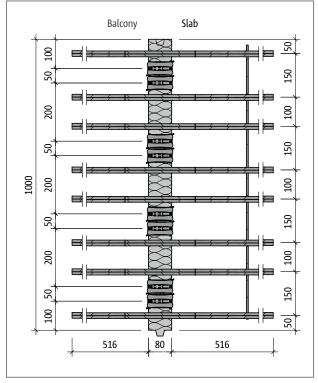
Schöck Isokorb® T type Q-E-VV5: Product layout
